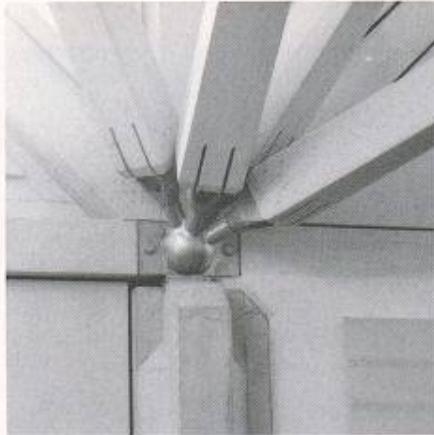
Anschluss Raumfachwerk an das ebene Fachwerk (Detail)
